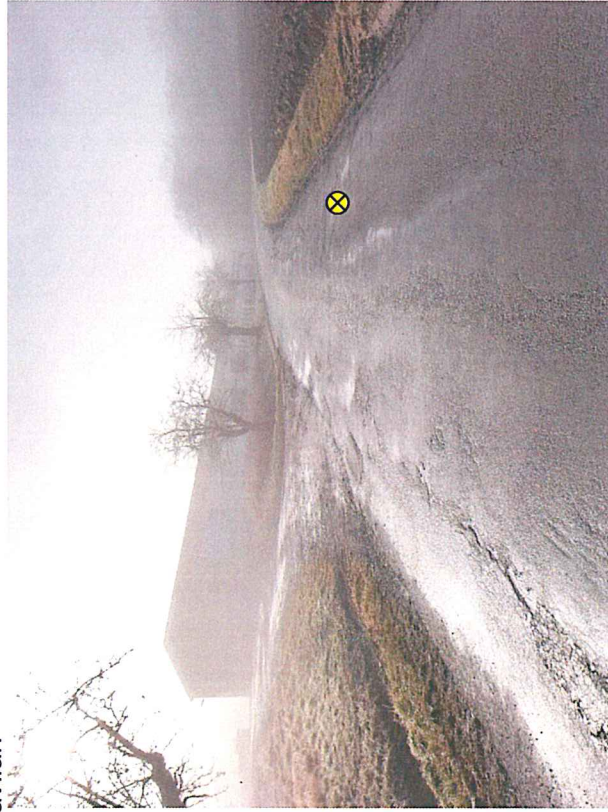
Detail místa odběru vývrtnu JV 1
